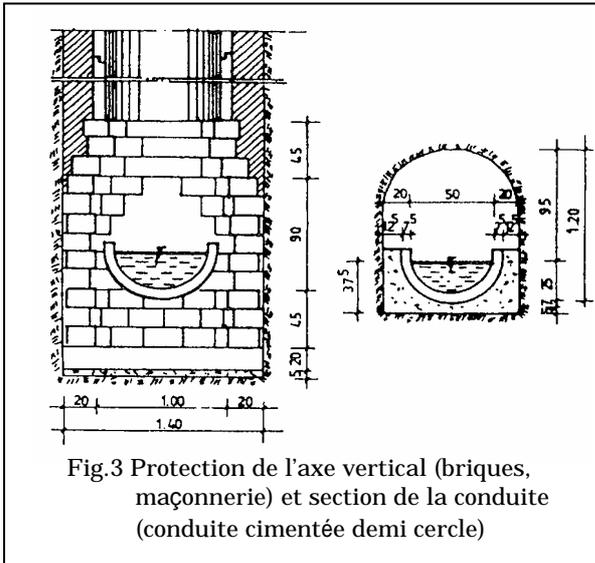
Protection de l'axe vertical (briques, maçonnerie) et section de la conduite (conduite cimentée demi cercle)
